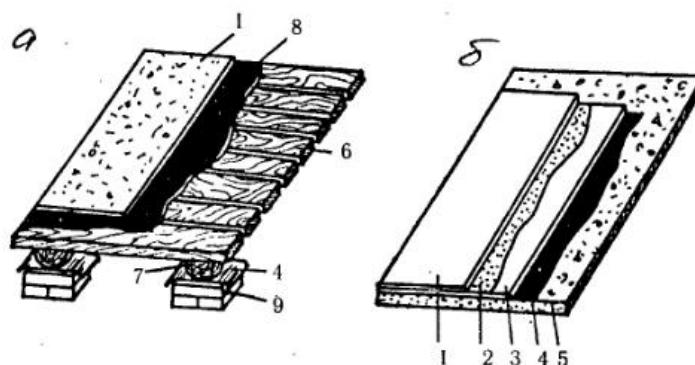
Конструкция пола из ДВП: а — на дощатом основании; б — на бетонном. 1 — ДВП; 2 — мастика; 3 — предохранительный слой цементного раствора по рувероиду; 4 — гидроизоляция; 5 — бетонная подготовка; 6 — дощатый настил; 7 — лаги; 8 — изоляционный слой; 9 — столбик из кирпича.
